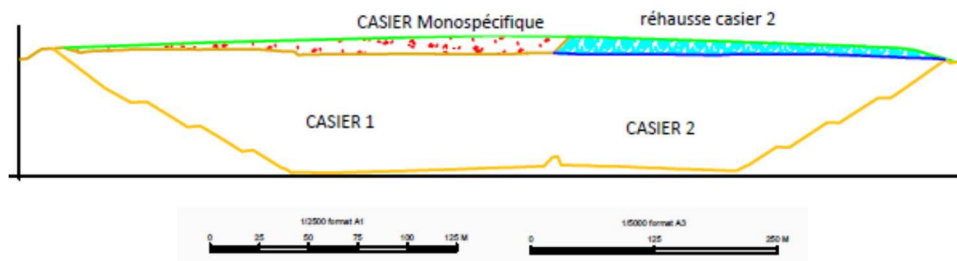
Implantation du casier MCCA (coupe et plan) – source APS ARCADIS
